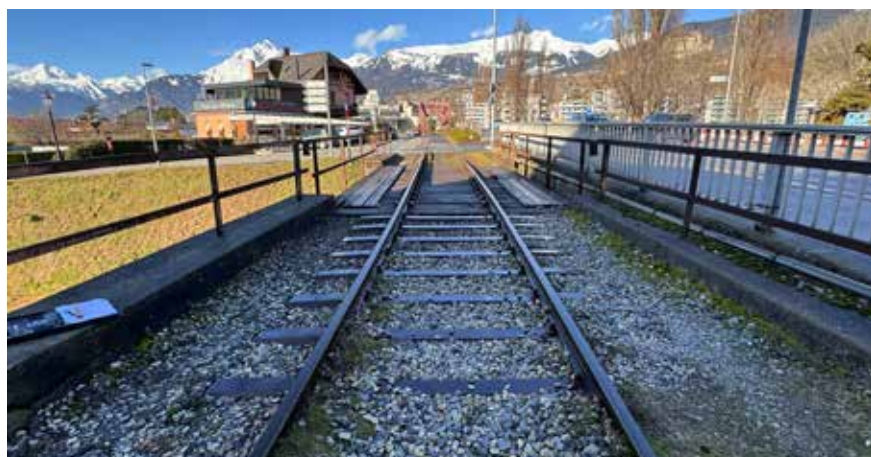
Pont du Canal avant l'installation des dalles STRAILgrid.
